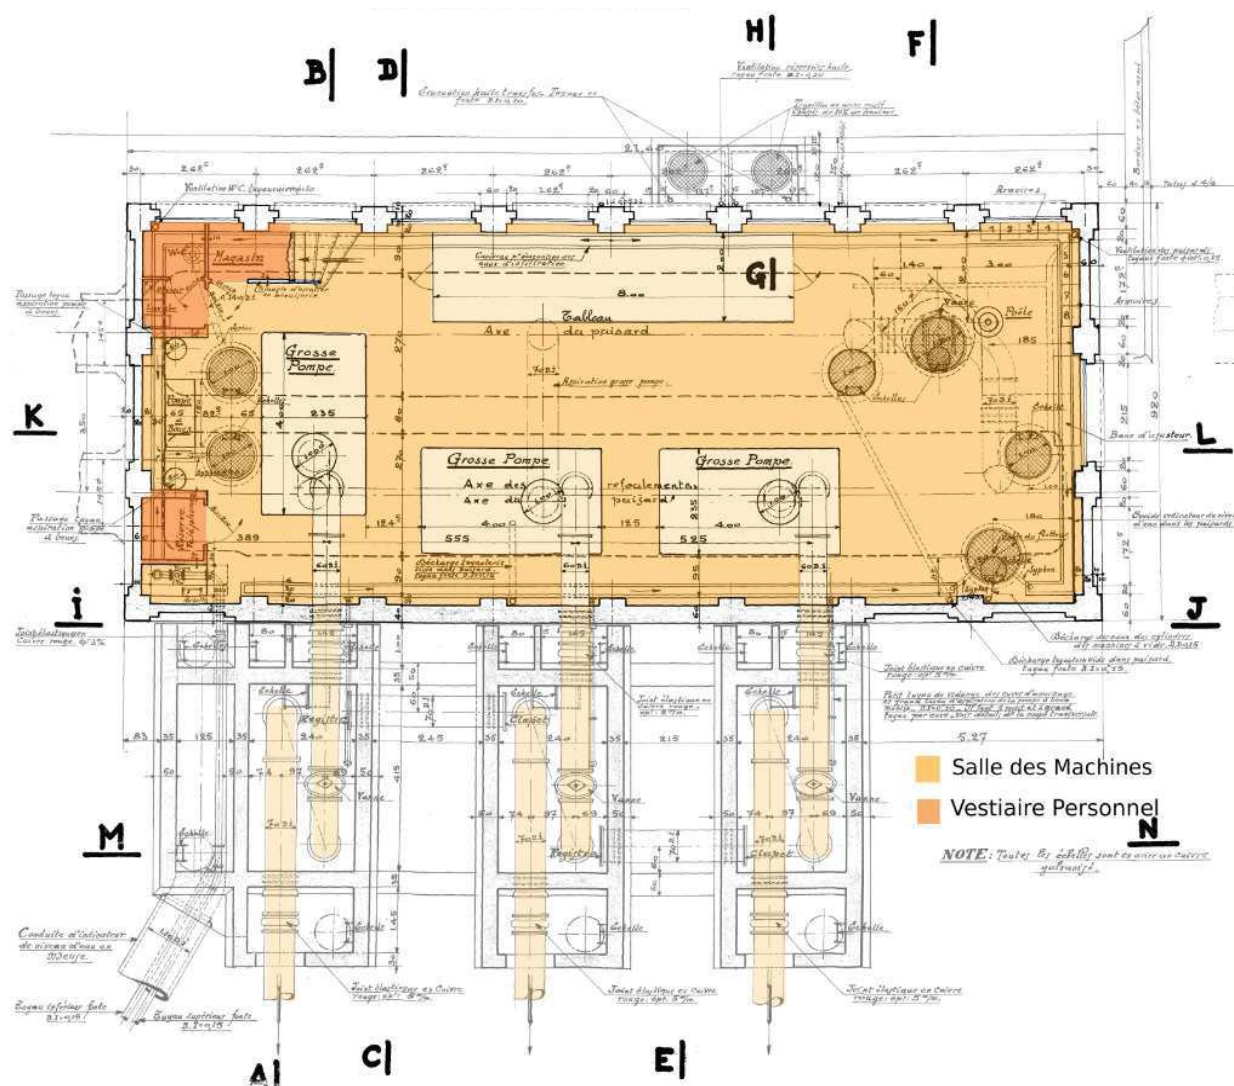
Plan du rez-de-chaussée – ech. 1/200
